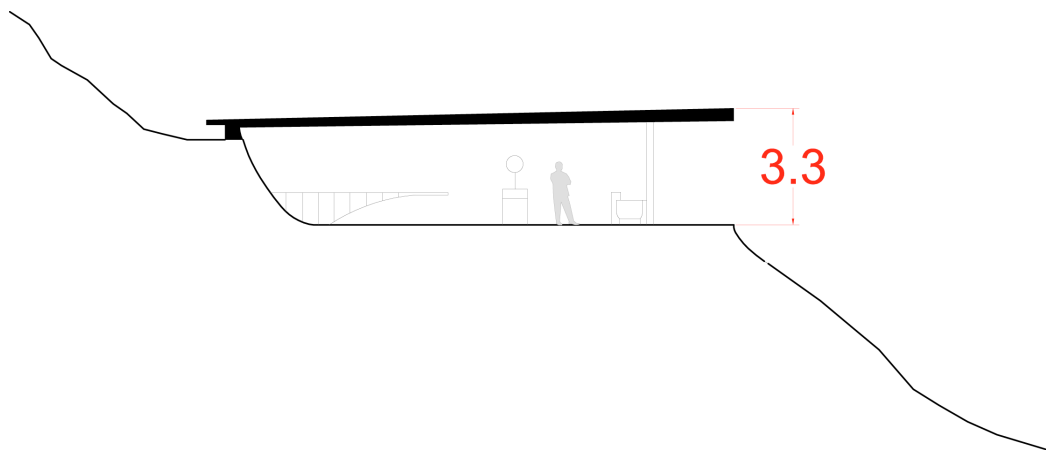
Alzado. Casa sin paredes (1997). Shigeru Ban.
